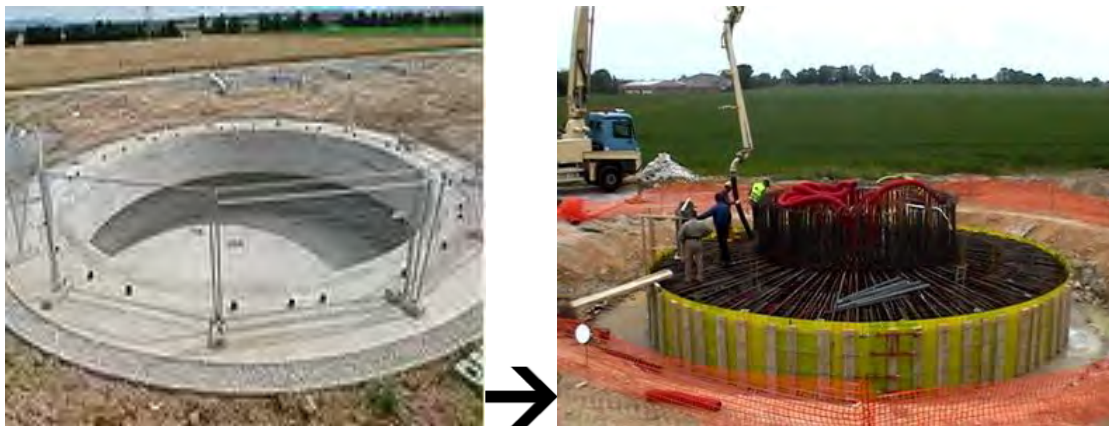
ferraillage et coulage de fondation superficielle d'éolienne on-shore [18]
